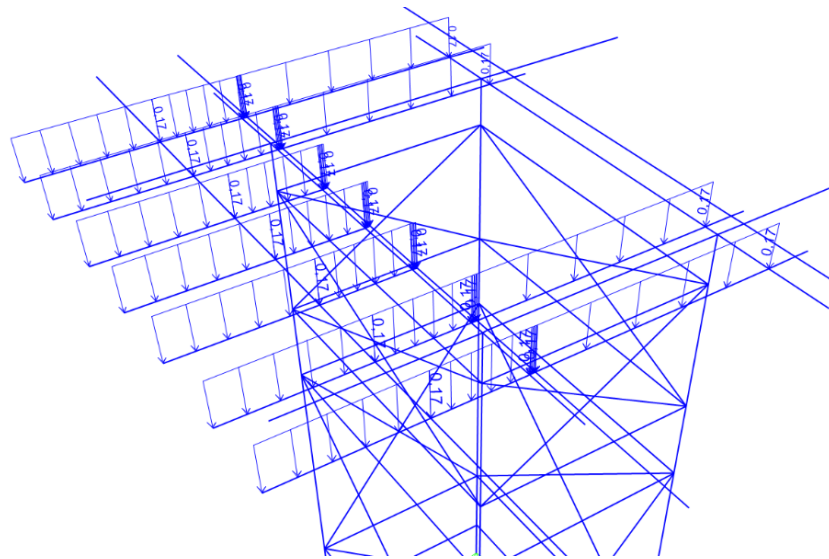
Ilustrasi Rangka *Tower Shoring* pada Pengecoran *Pier Head
